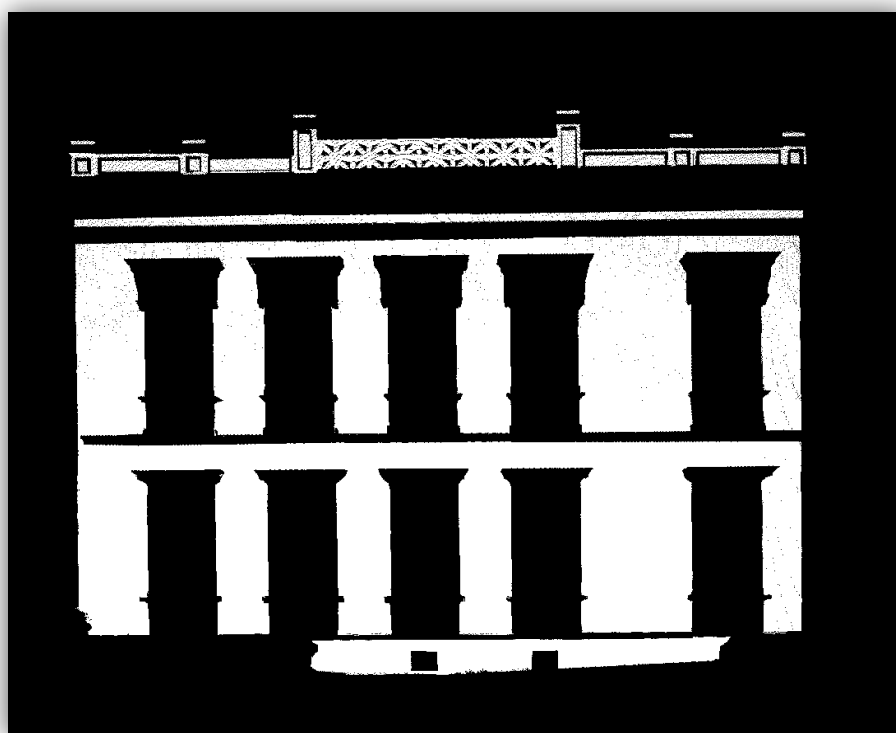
PLANO SEGMENTADO – PAREDE PRINCIPAL
